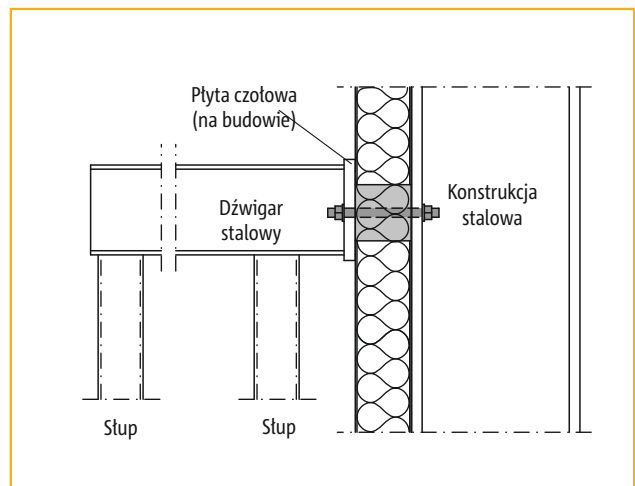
Schöck Isokorb® typu KST do wspornikowych konstrukcji stalowych
